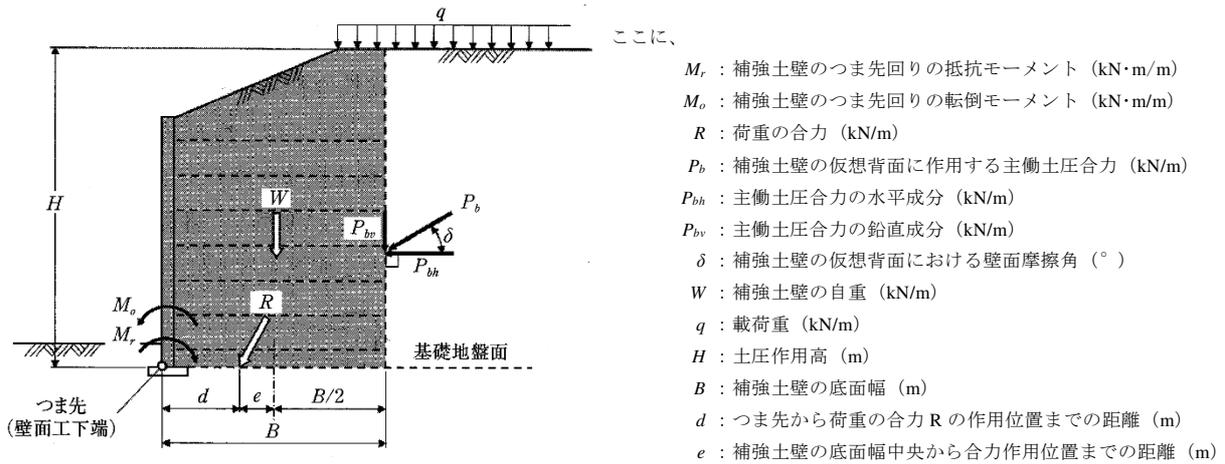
作用荷重と合力の作用位置の考え方⁸⁾
